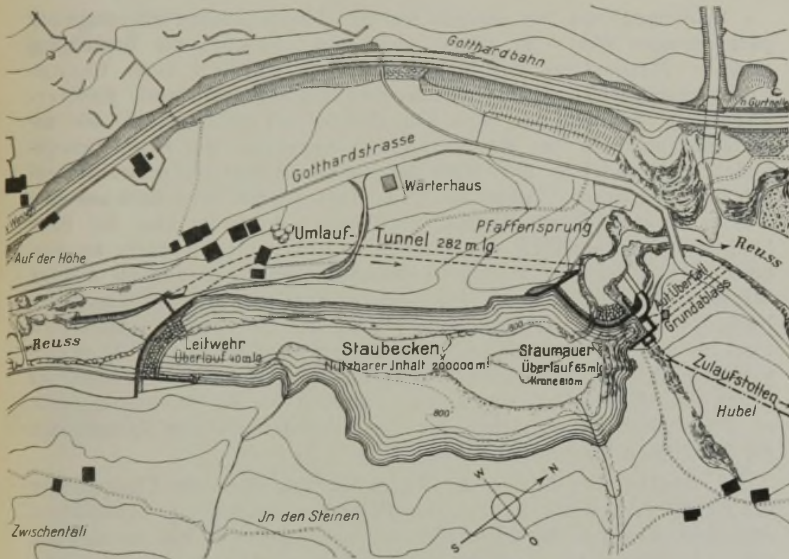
Lageplan des Speicherbeckens Amsteg. (Schweizer Bundesbahnen.)
